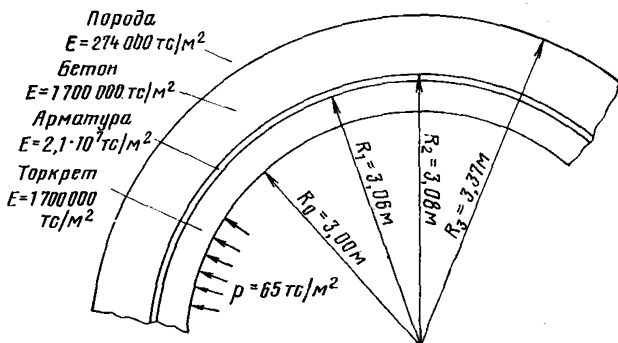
Схема конструкции; толщина бетонной обделки 30 см, толщина железоторкрета 7 см
